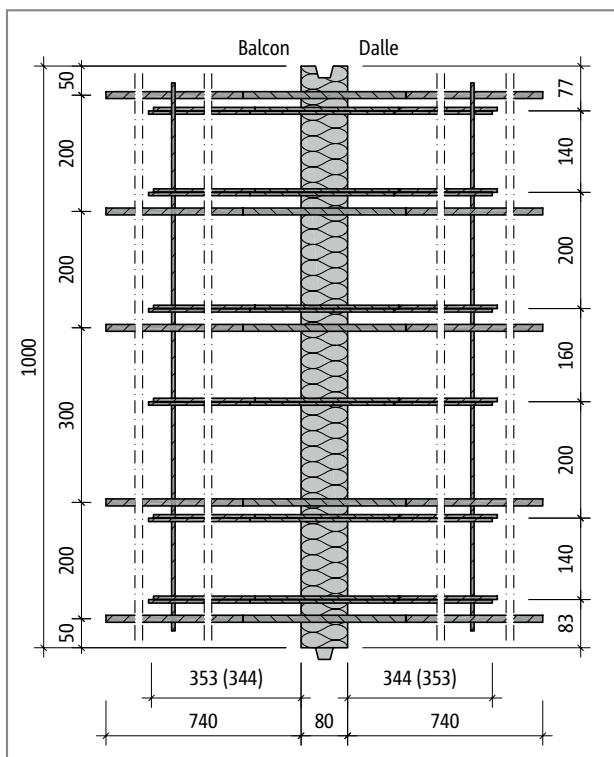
Schöck Isokorb® T Type D-MM2-VV1 : Plan de base
